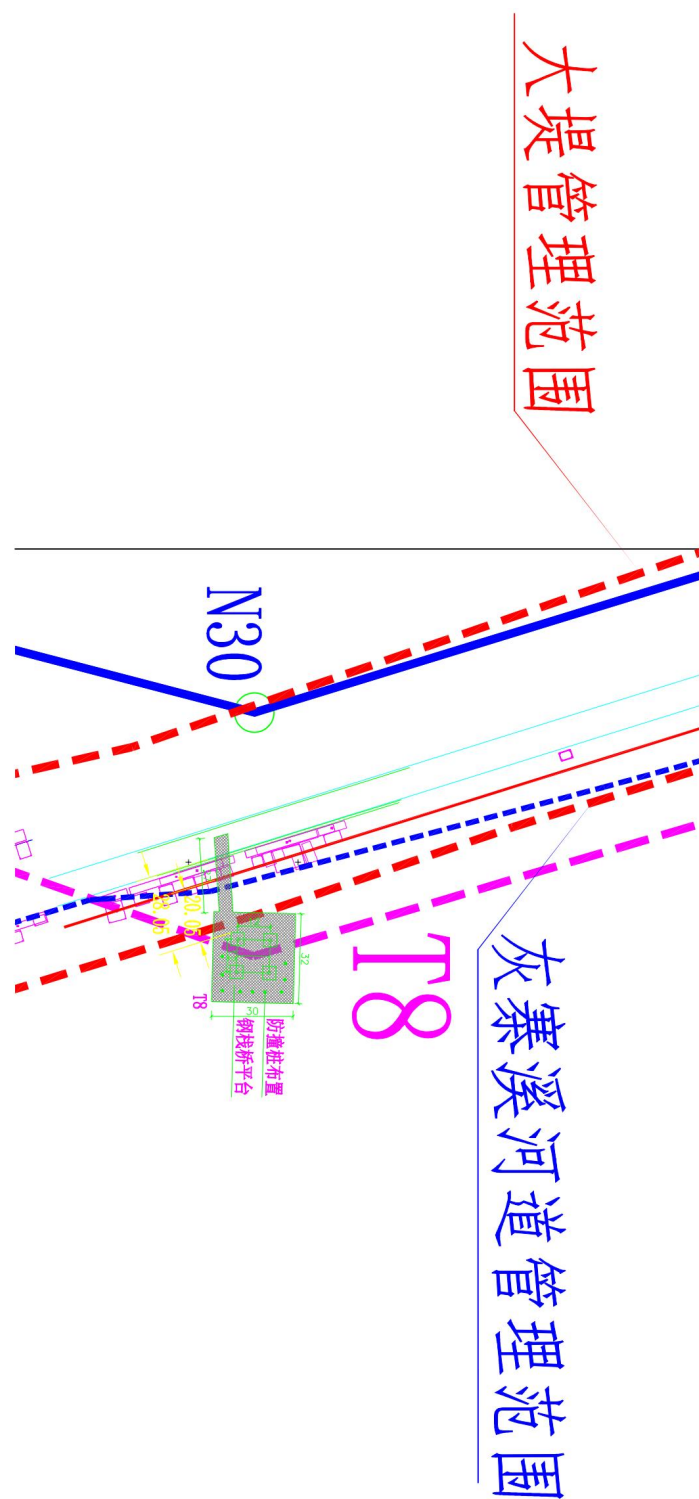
塔基 T8 占用河道管理范围平面示意图
